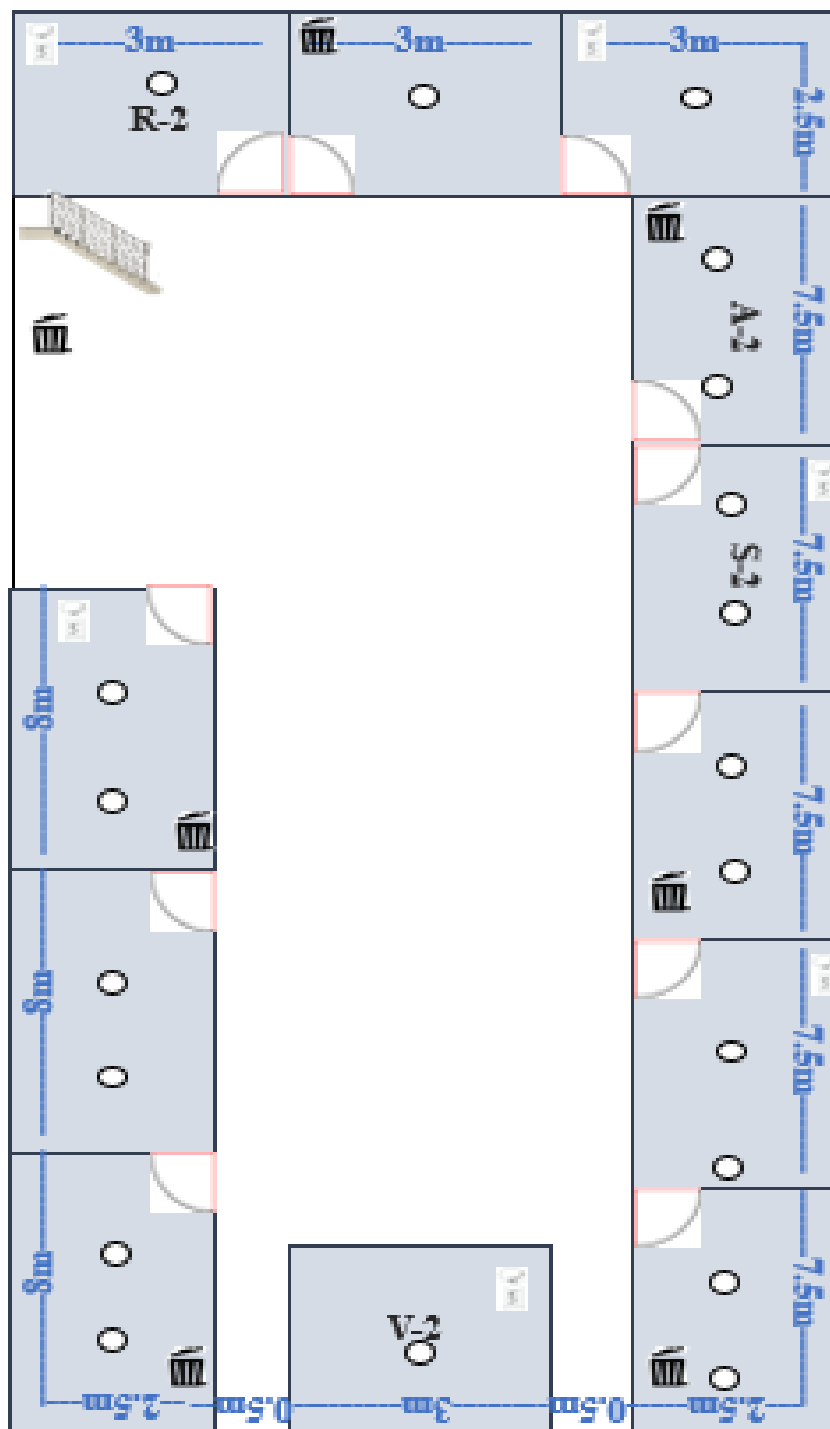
Diseño de planta BANLEMA S.A.C (SEGUNDO PISO)
